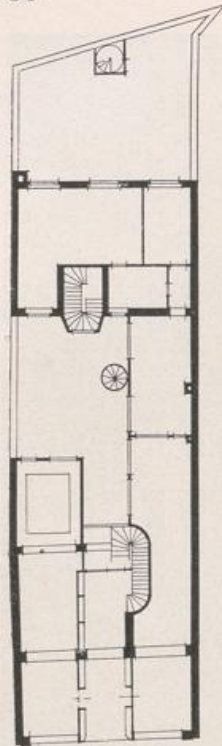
Schadowstrasse 47. Erdgeschoss. 1:500.
